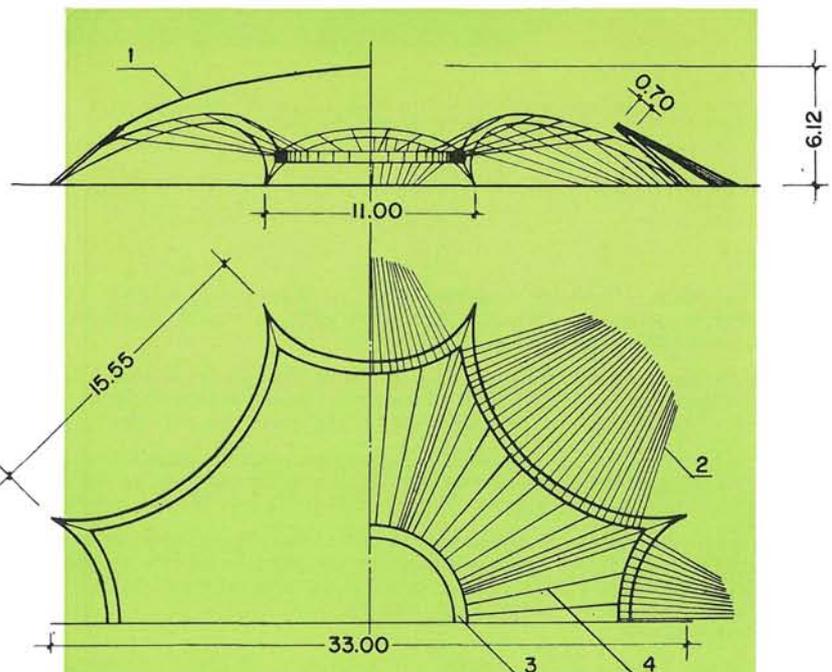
Planta y alzado-sección de la cúpula del Pabellón Ferial de Barcelona.
